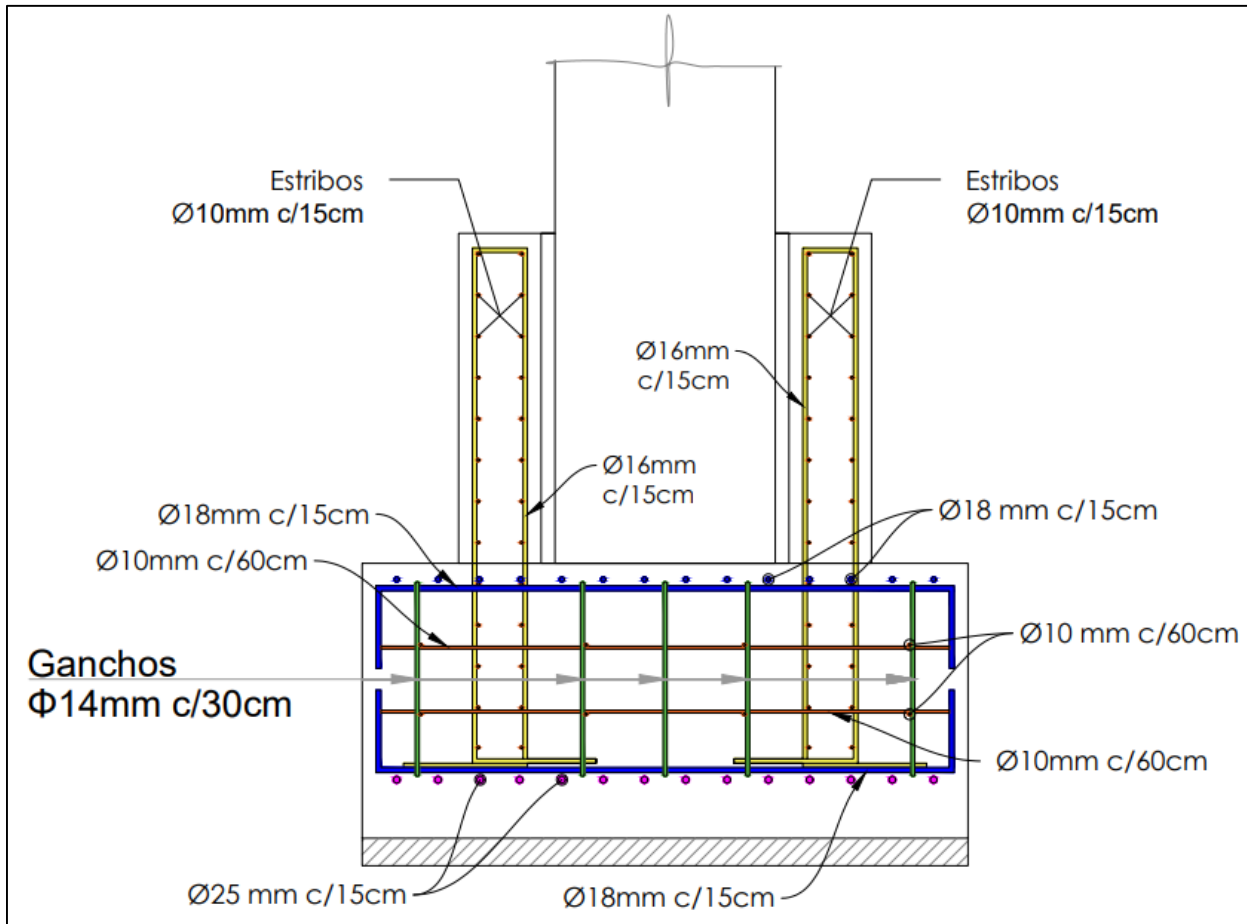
Armado de la zapata tipo candelero en el corte B-B'. Referente a la figura 18. Fuente del autor.
